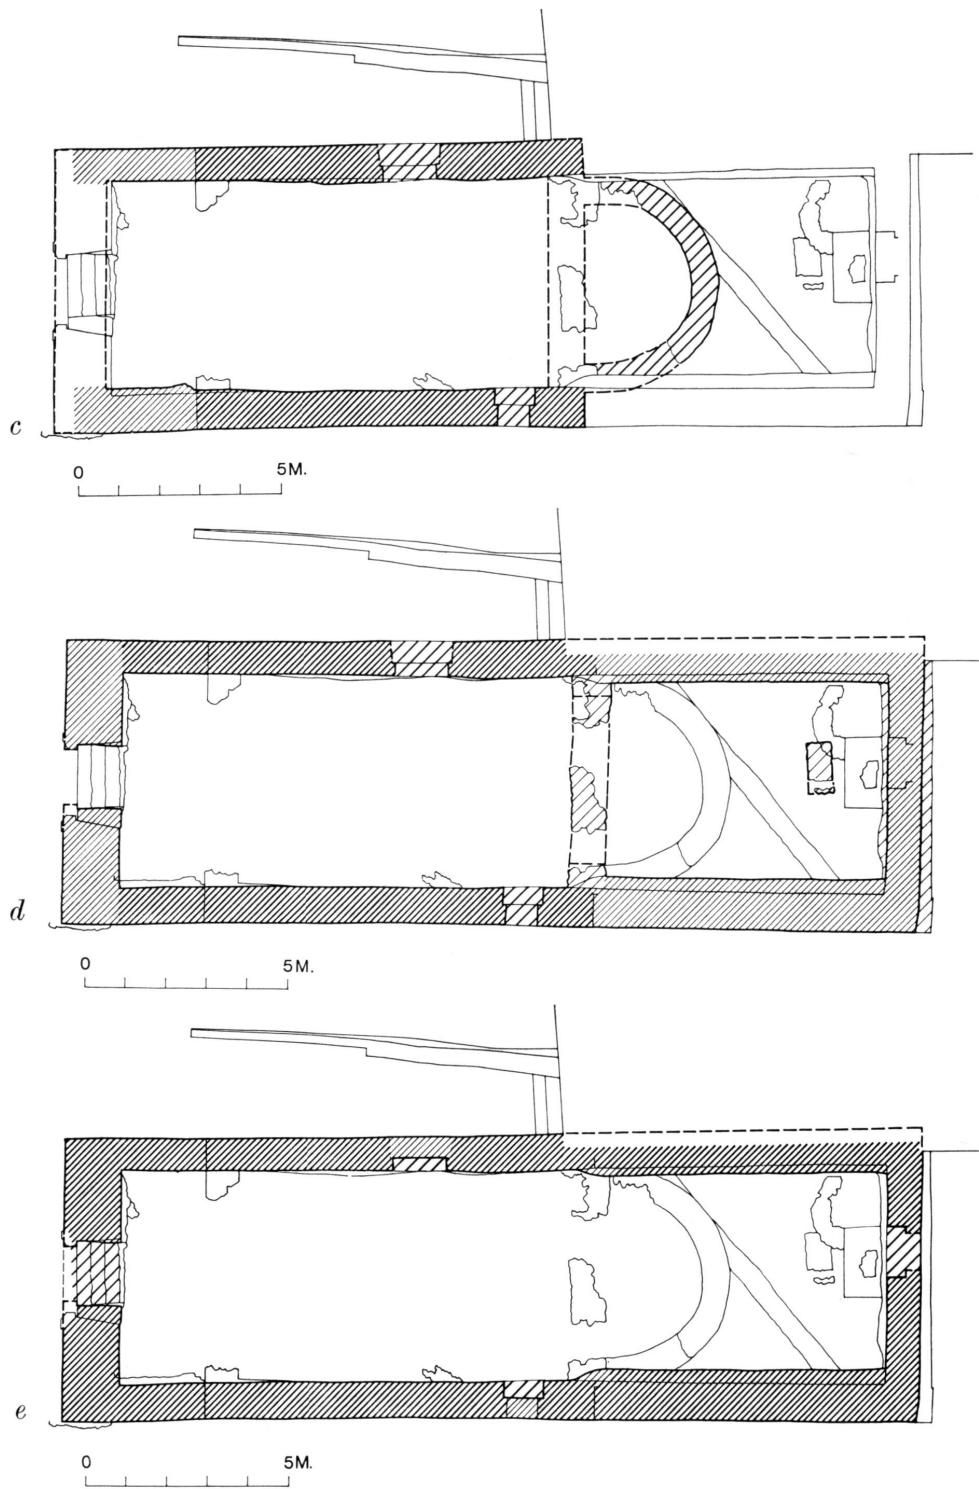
Temple de Russin. Plans schématiques des fondations anciennes.
